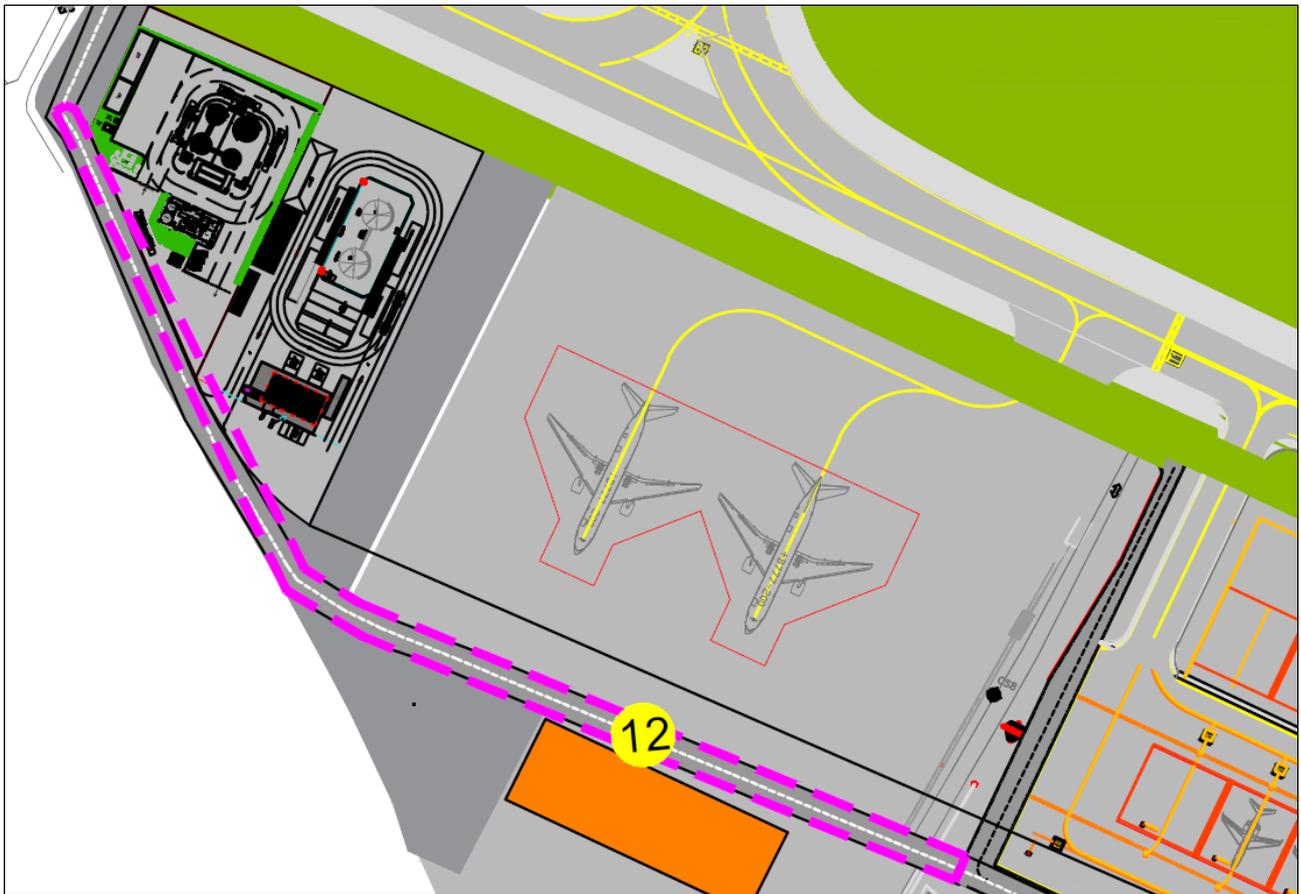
Estratto Master Plan – Nuova Viabilità Perimetrale
